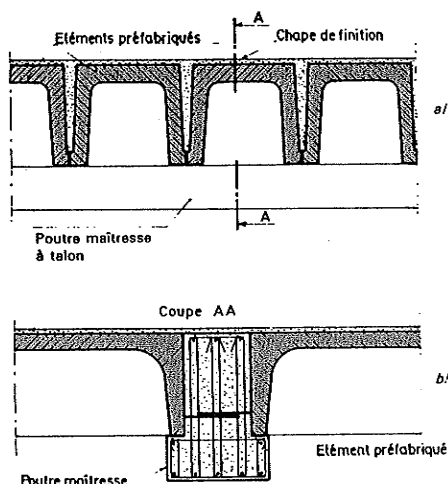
Plancher industriel (fortes surcharges et grande portée).
